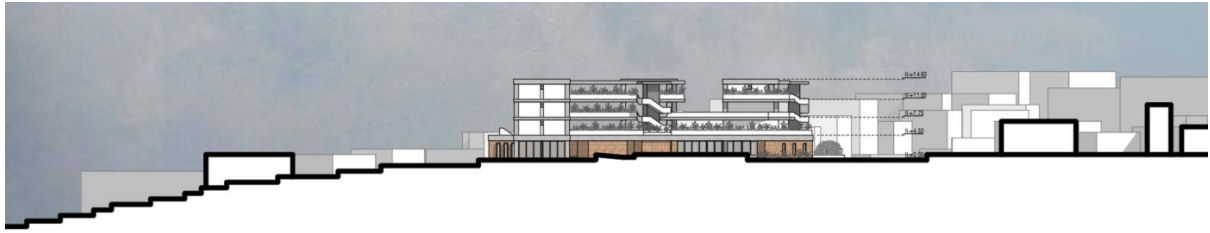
Elevación norte - Proyecto definitivo. Elaboración propia.
